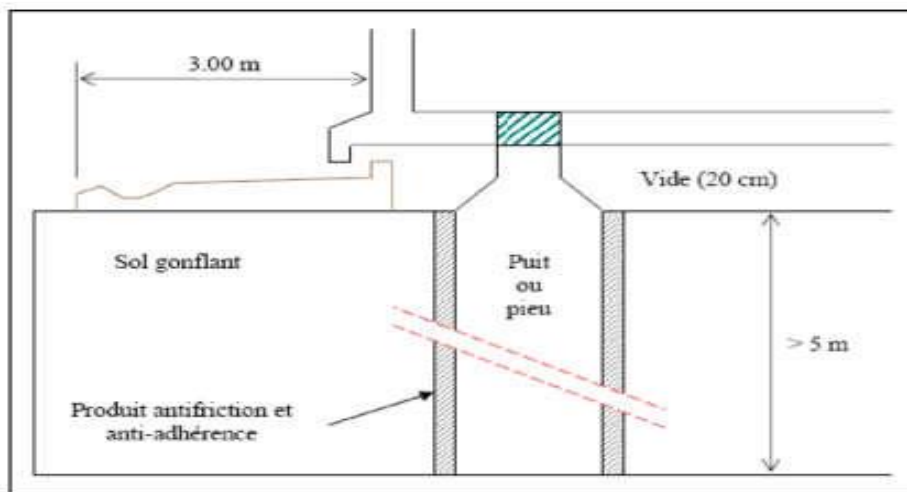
Fondation profonde (puits ou pieux)(Ferrah, 2006).
